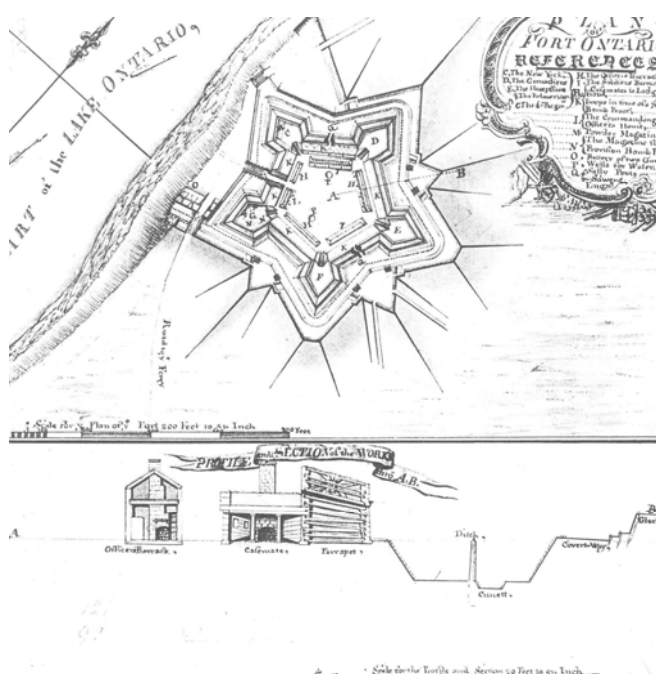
Forte Ontario, New York (1759-63). Thomas Sowers, engenheiro. Plano e perfil desenhados pelo engenheiro (1759). Fonte: Robinson, 1977.
